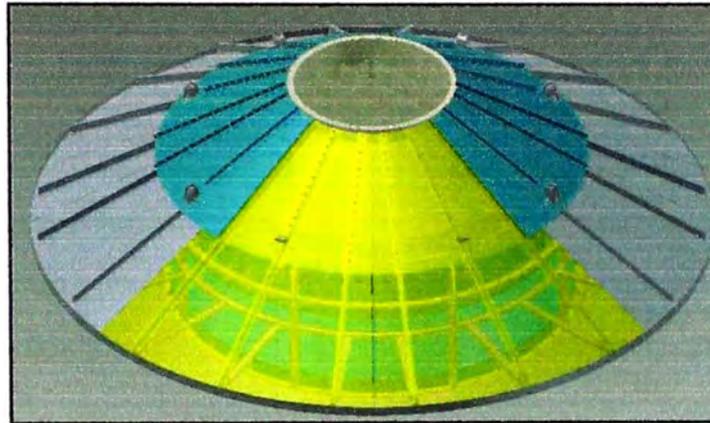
Montaje del Techo Cónico sobre Anillos 10-11
